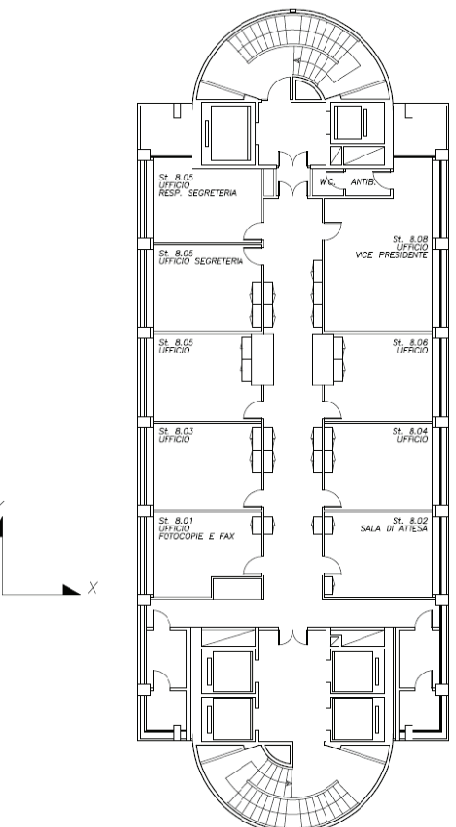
Pianta piano tipo dal piano 8° al piano 18°
